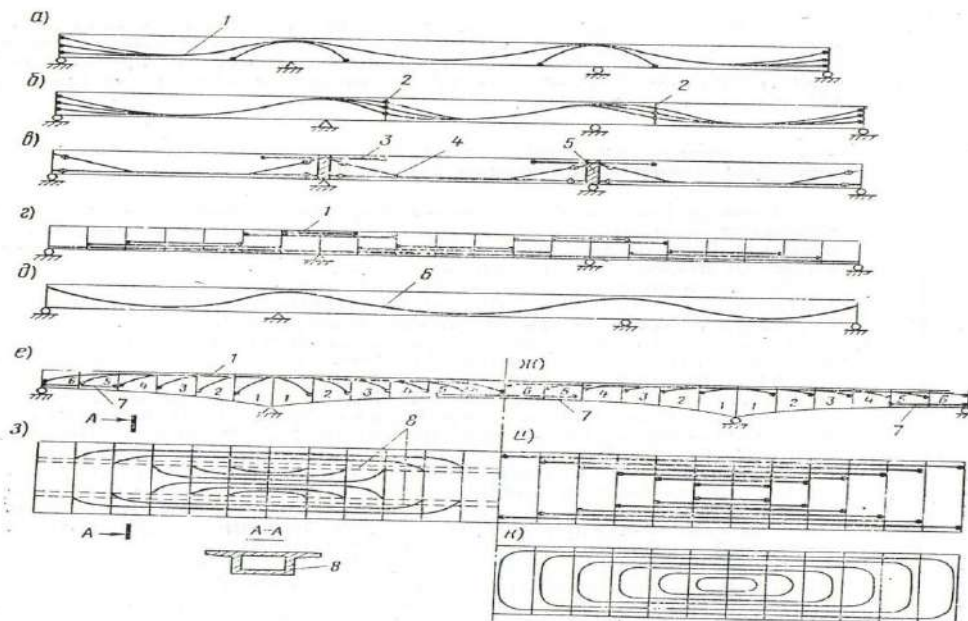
Схемы армирования неразрезных балочных пролетных строений с напрягаемой арматурой:
